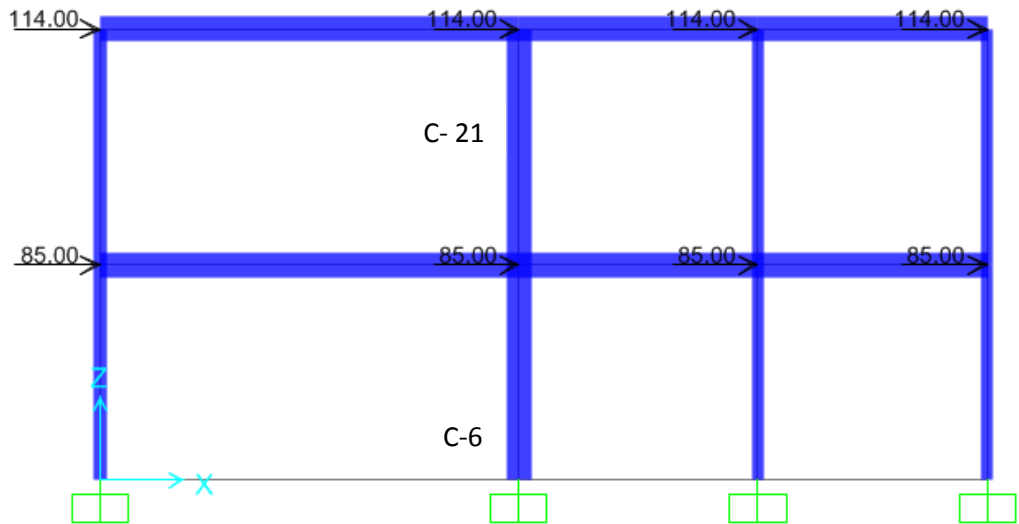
Pórtico eje 2 – Fuerzas Horizontales en X
